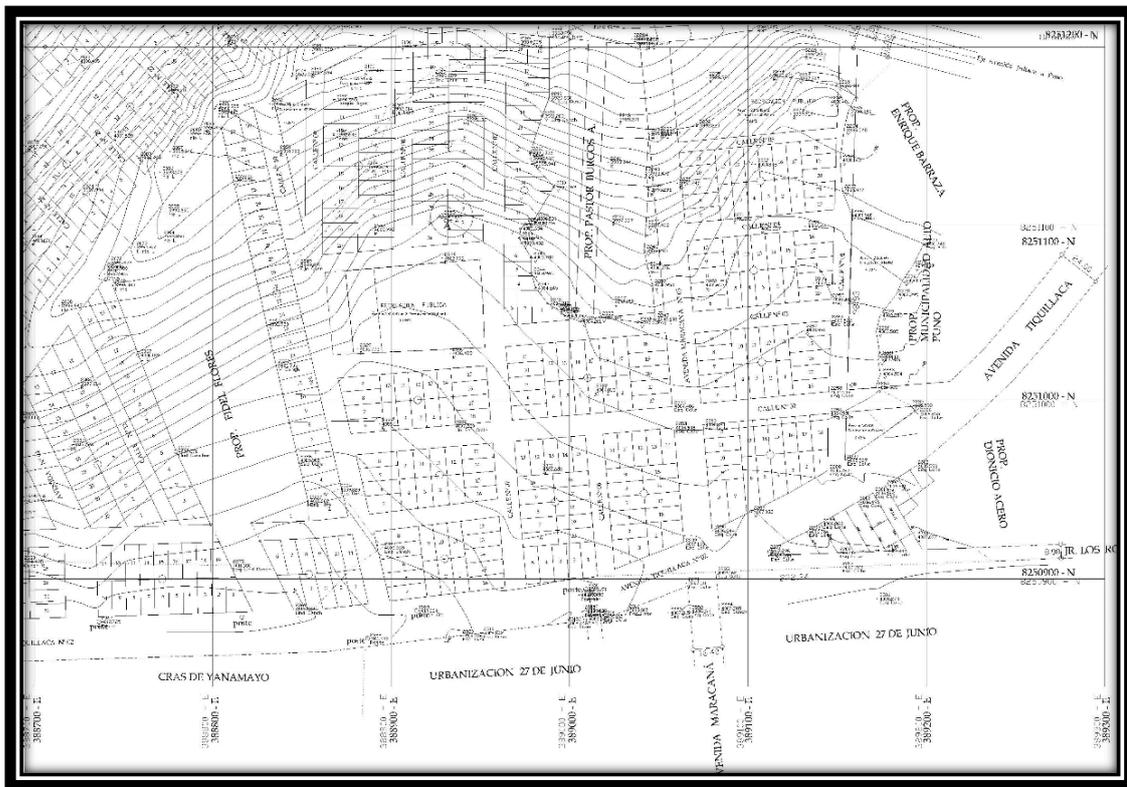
Plano de ubicación para proyecto de centro de salud I-4.
